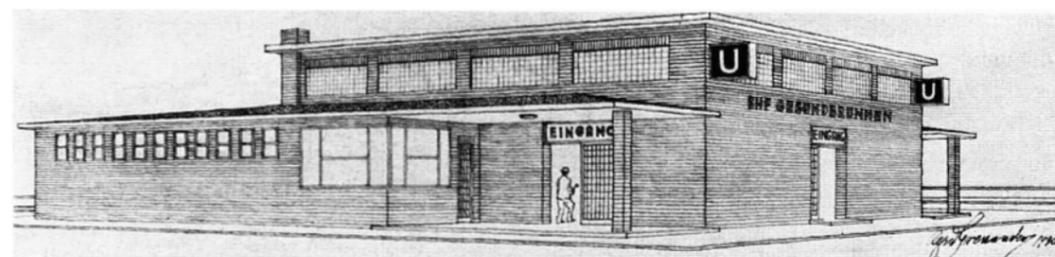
Eingangshalle zum Bahnhof Gesundbrunnen.
